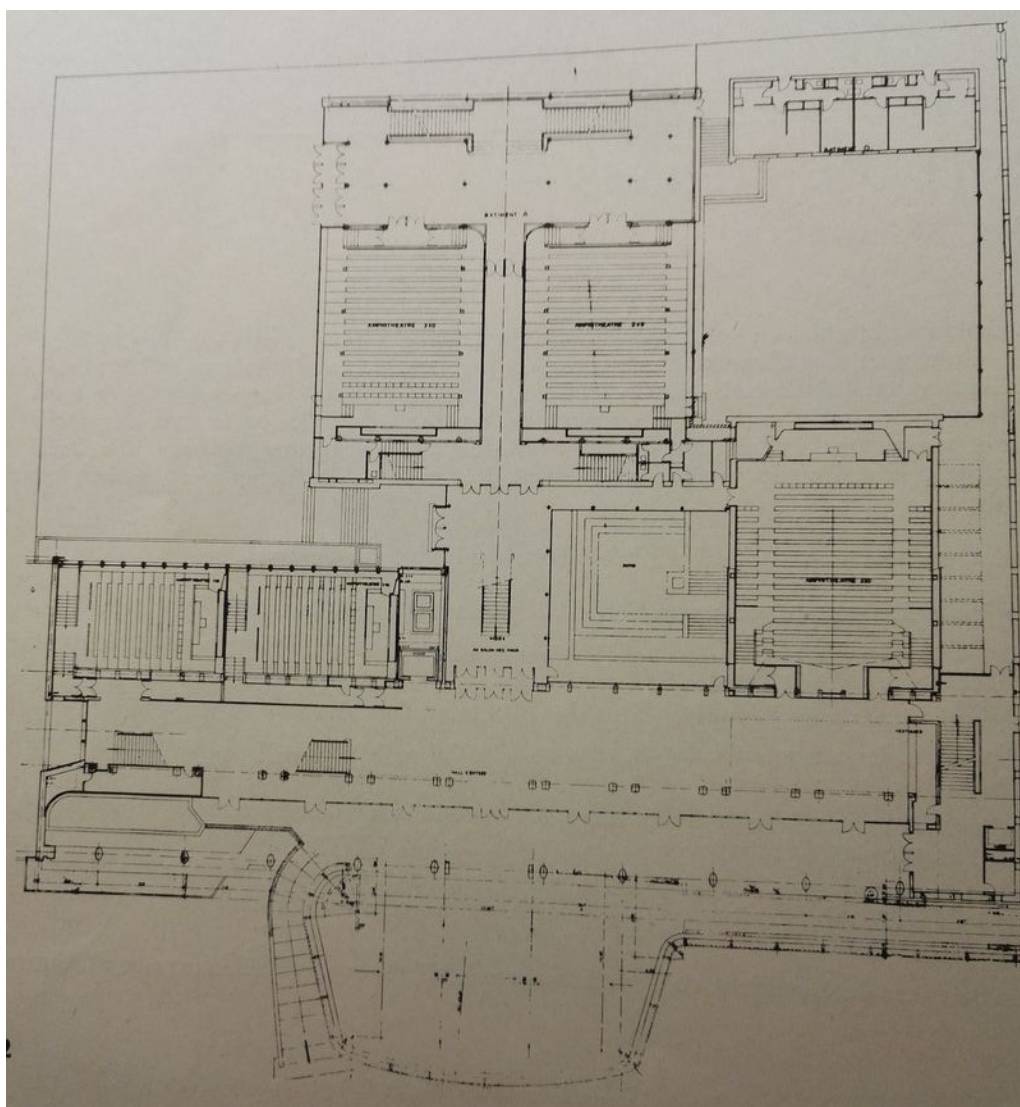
Plan de la faculté de droit de Rennes. *L'Architecture Française* n° 275-276, juin-août, 1965, p. 92
